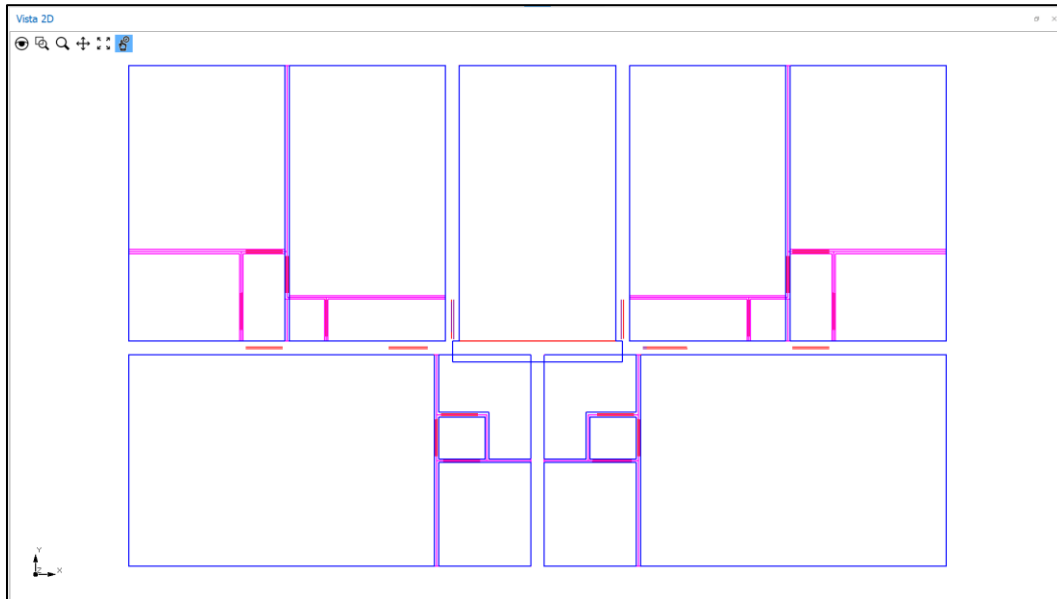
Rappresentazione 2D delle frontiere di un edificio – Proiezione ortogonale vista dall'alto
